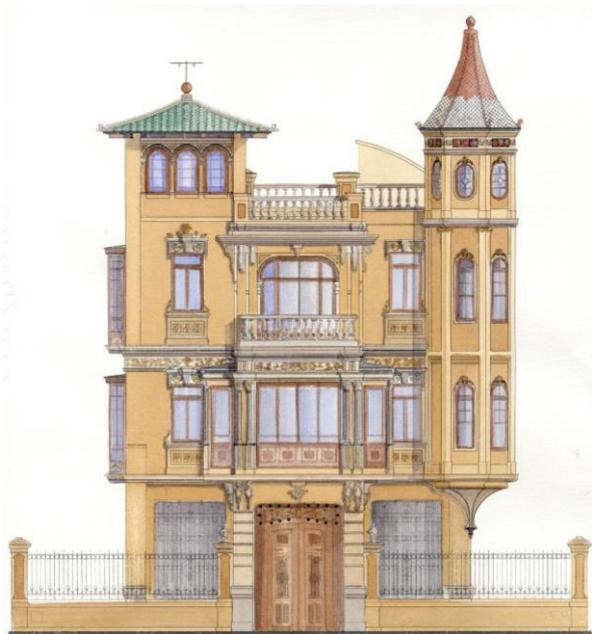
Propuesta de color para la fachada principal del edificio, alzado Norte.
